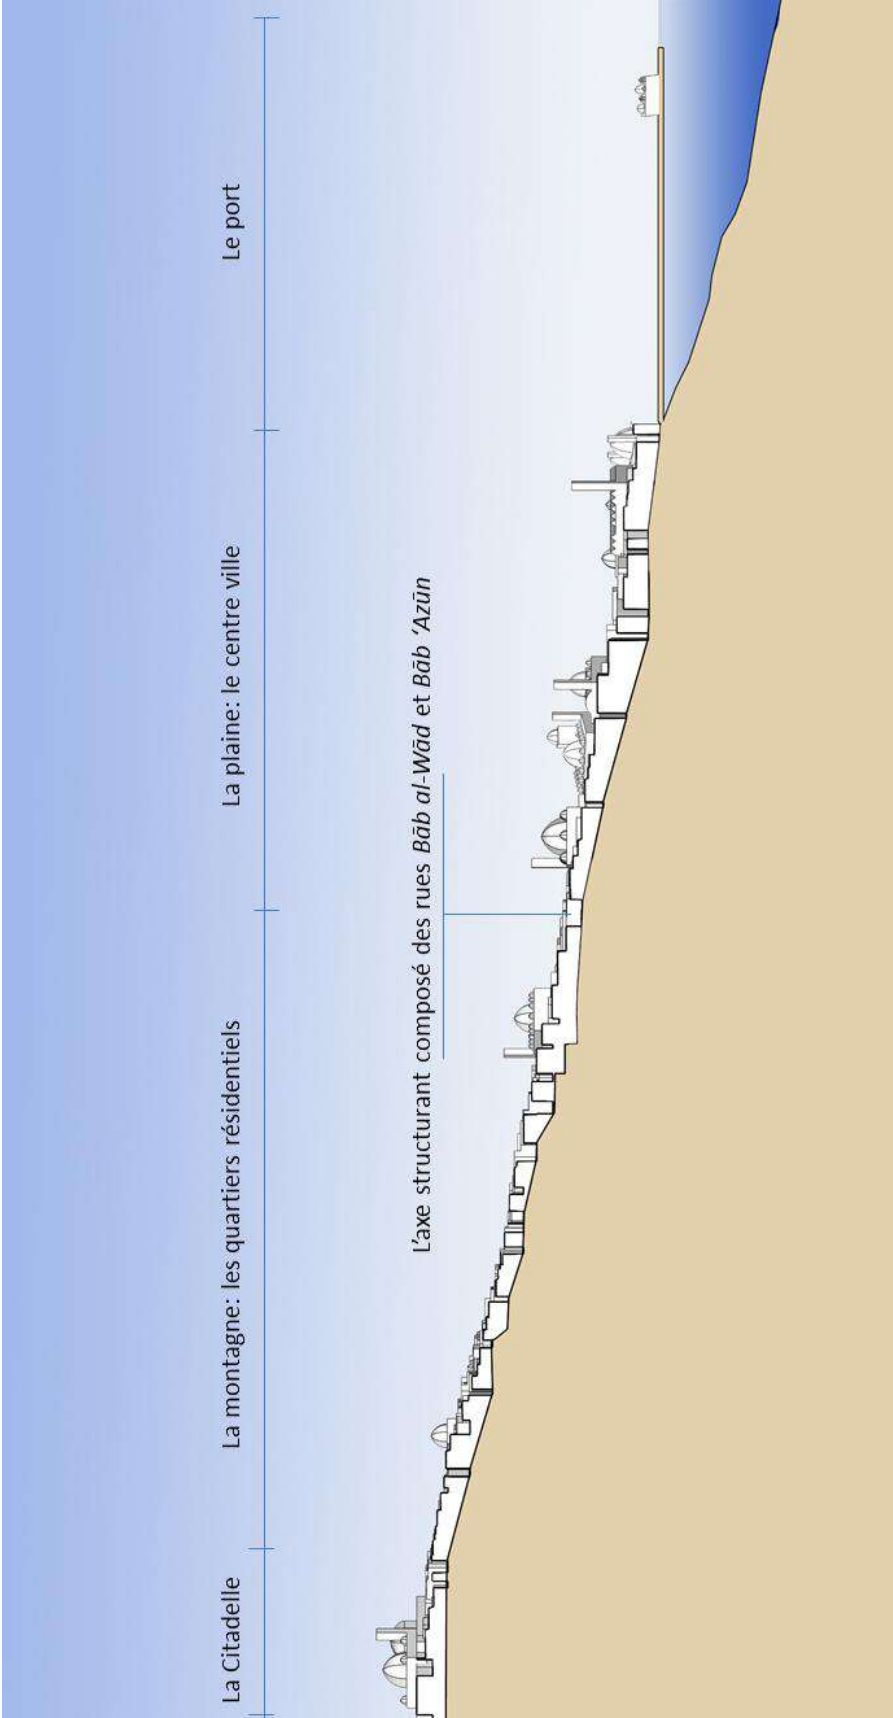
Coupe longitudinale sur la ville d'al-Djazā'ir.
